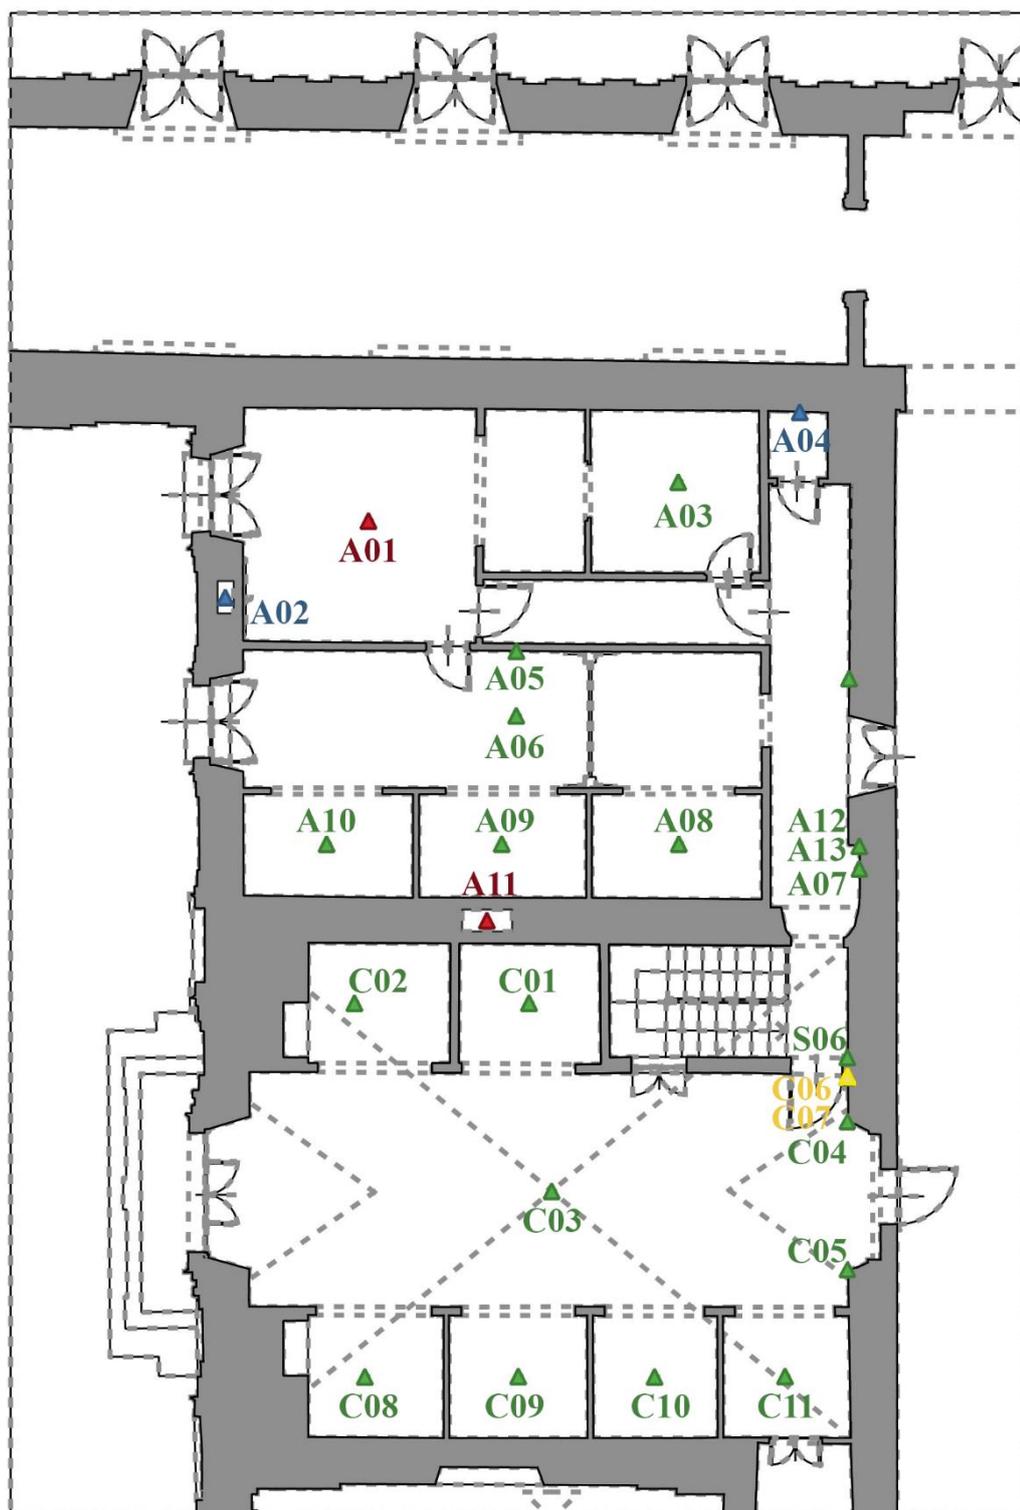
Restituzione proposta di intervento impianti nucleo del teatro - secondo piano nobile
